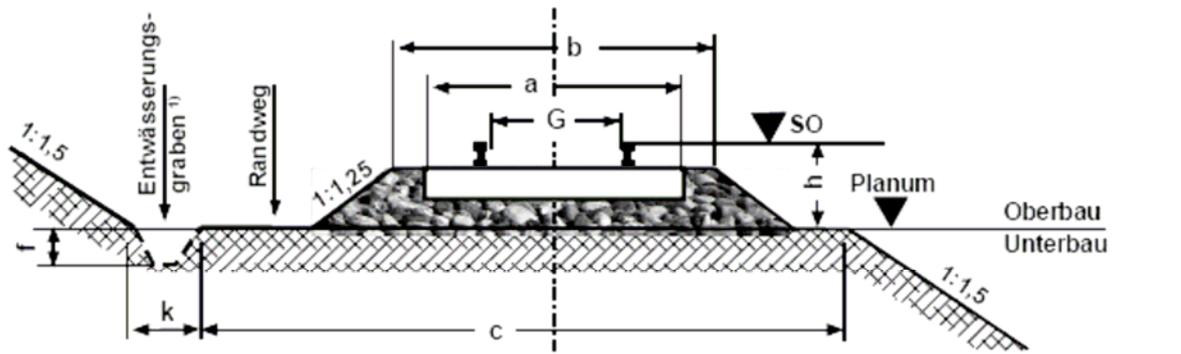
Aufbau des Bahnkörpers einer Schmalspurbahn
